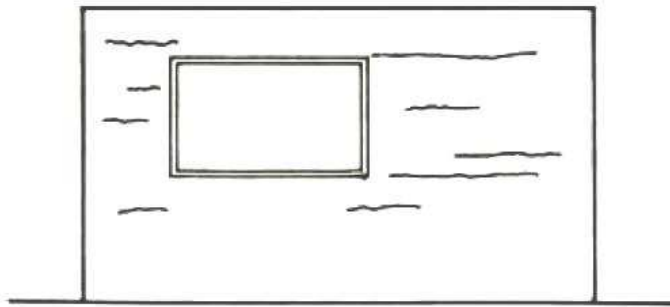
Fissuras horizontais no sistema de revestimento (Thomaz, 1989).
